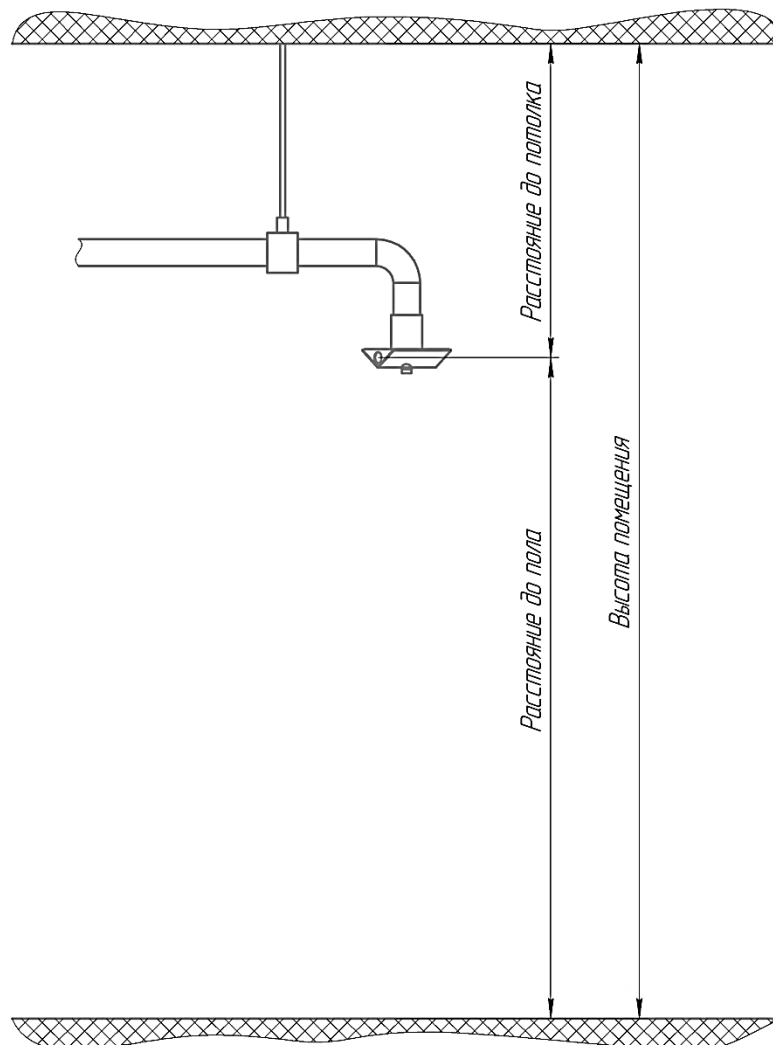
Схема расположения оросителя ОПР-375Н на распределительном трубопроводе
